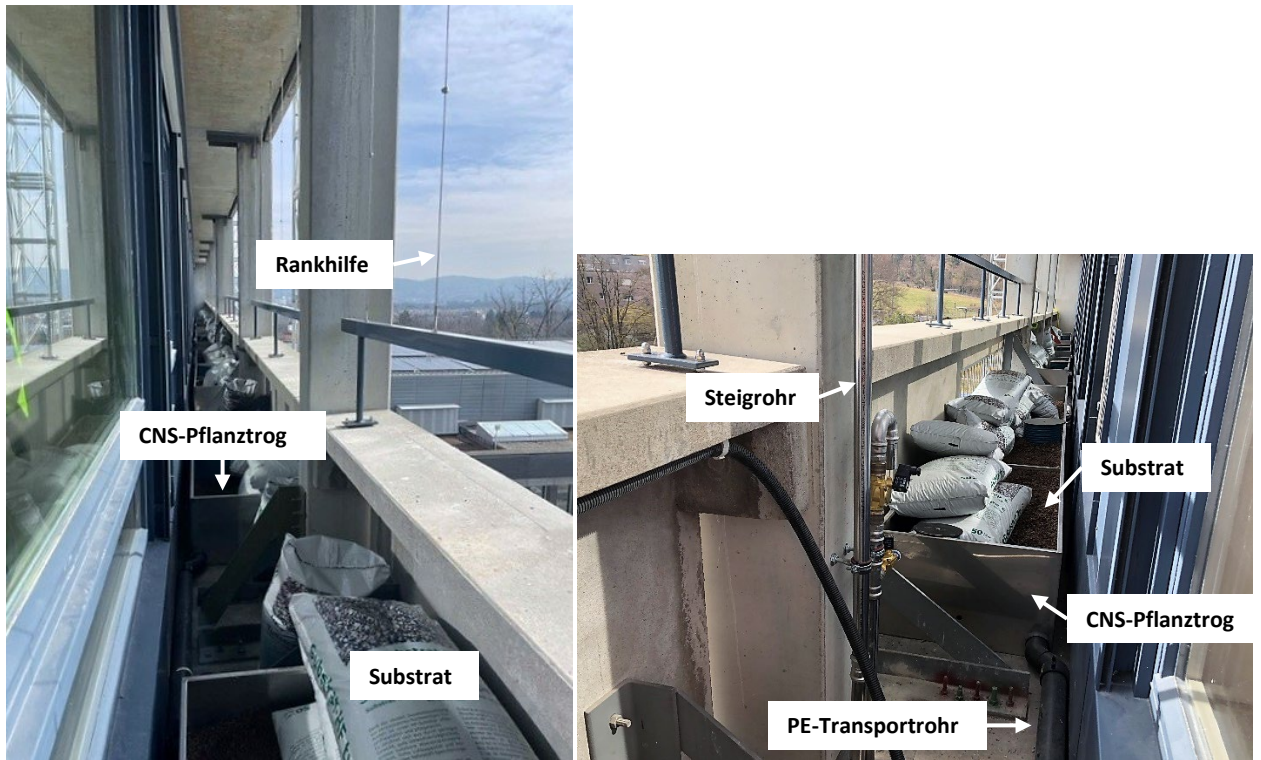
Fassadenelemente während der Erstellung der Fassadenbegrünung. Im Bild links sind Pflanztröge, Substrat und die Edelstahlseile der Rankhilfe zu sehen. Im Bild rechts ist nebst Pflanztrögen und Substrat das Edelstahl-Steigrohr des Bewässerungssystems abgebildet. (Fotos: ZHAW)
